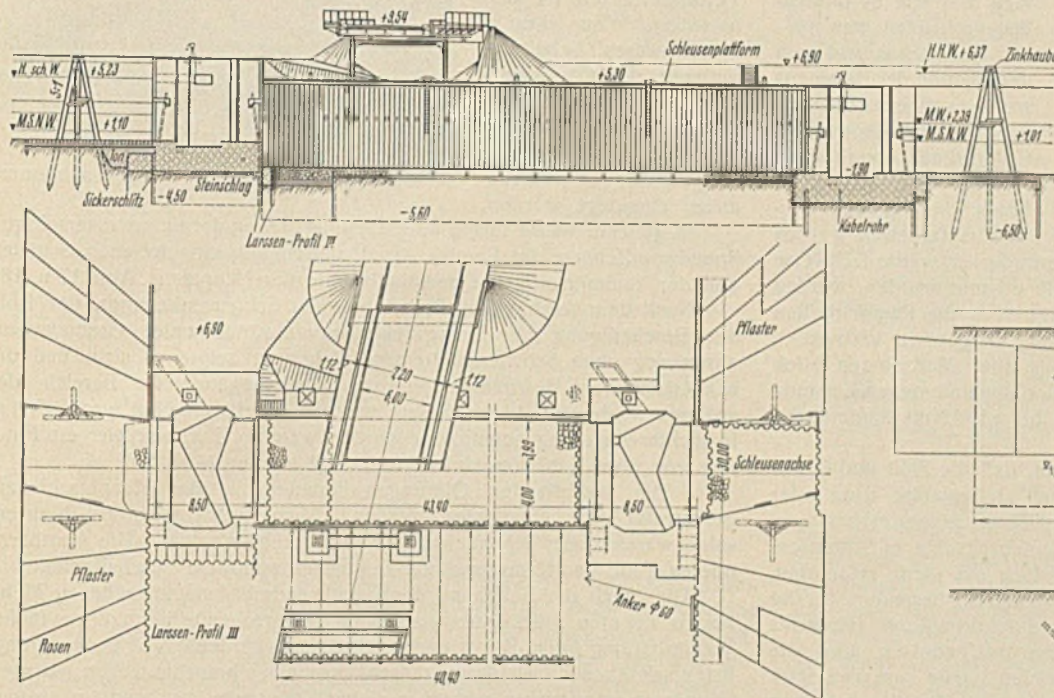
Längsschnitt und Grundriß der Schleuse.
